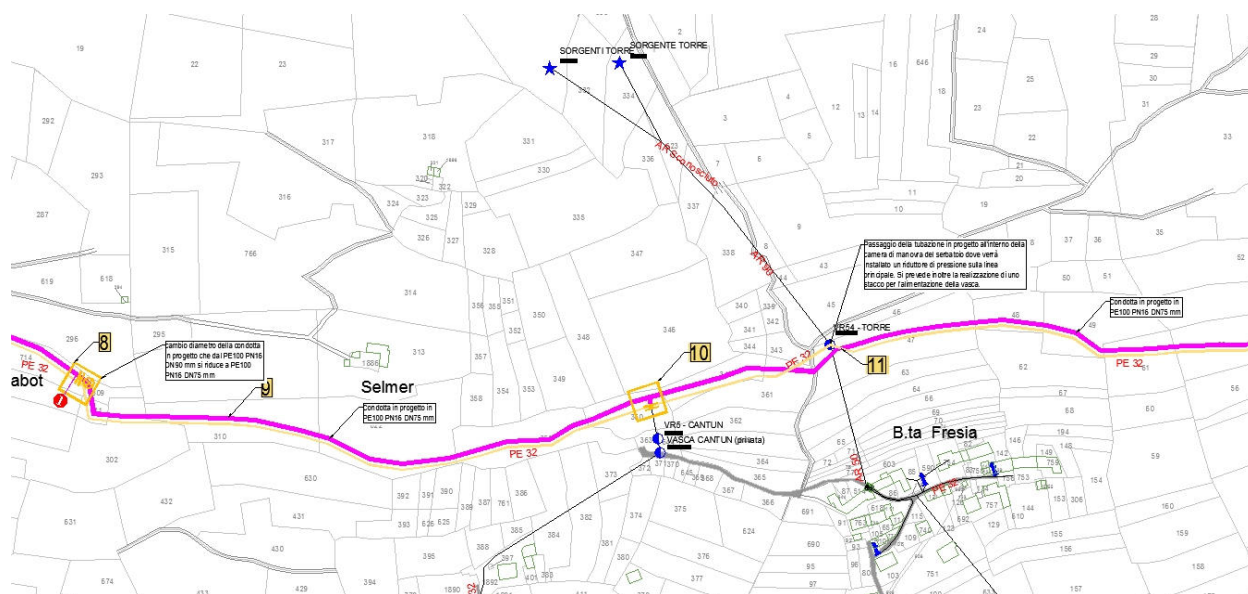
nuova condotta a progetto tra la Sezione 8 e la Sezione 11 su stralcio planimetria catastale.
